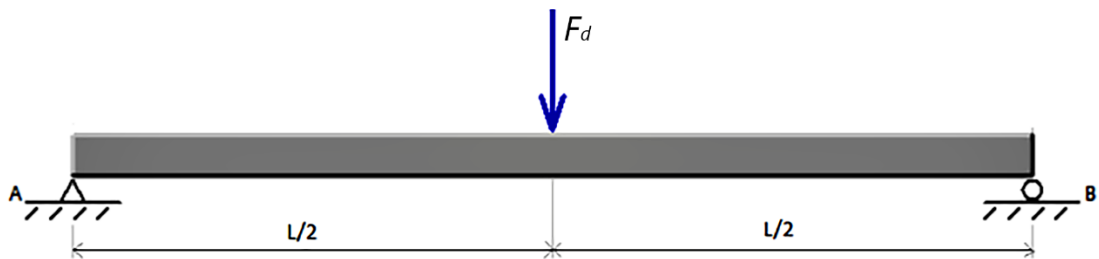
Viga simplesmente apoiada com carga a meio vão, [8].
